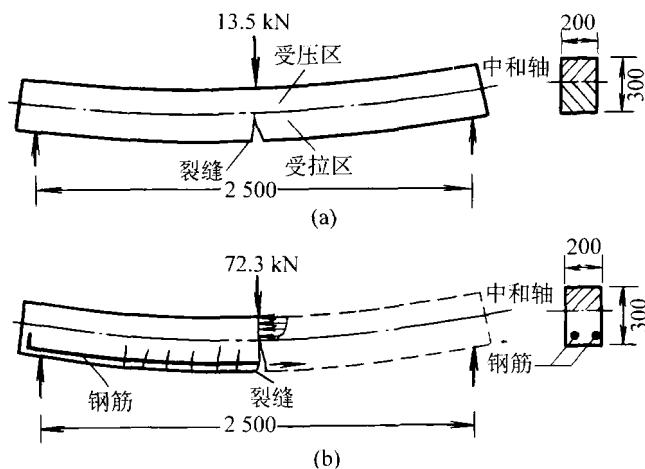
素混凝土与钢筋混凝土简支梁的破坏情况对比
